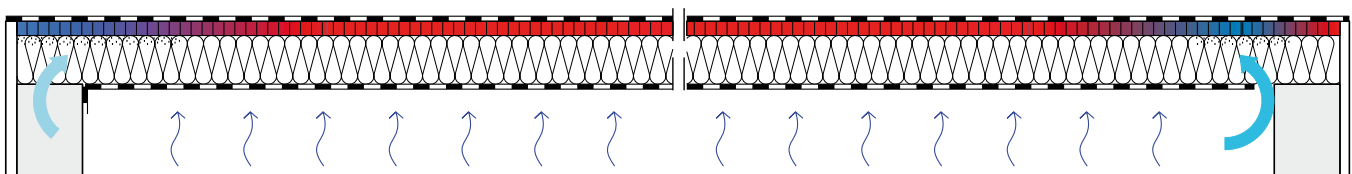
Ursachen für Feuchteintrag in die Dachkonstruktion – links: Bauteilaustrocknung (Nassbau) in das Dach, rechts: Konvektion durch undichten Bauteilanschluss – beides muss durch geeignete Maßnahmen verhindert werden.
